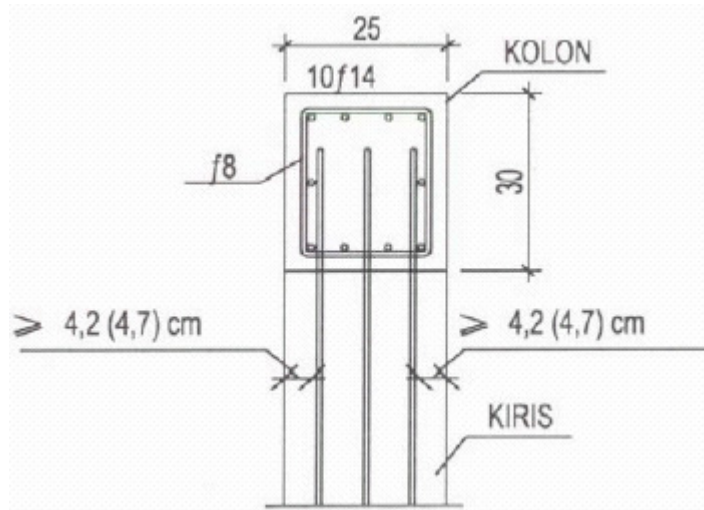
Kolon donatılarının ucunda kanca yapılması sonucu betonun patlamasına yol açar.
